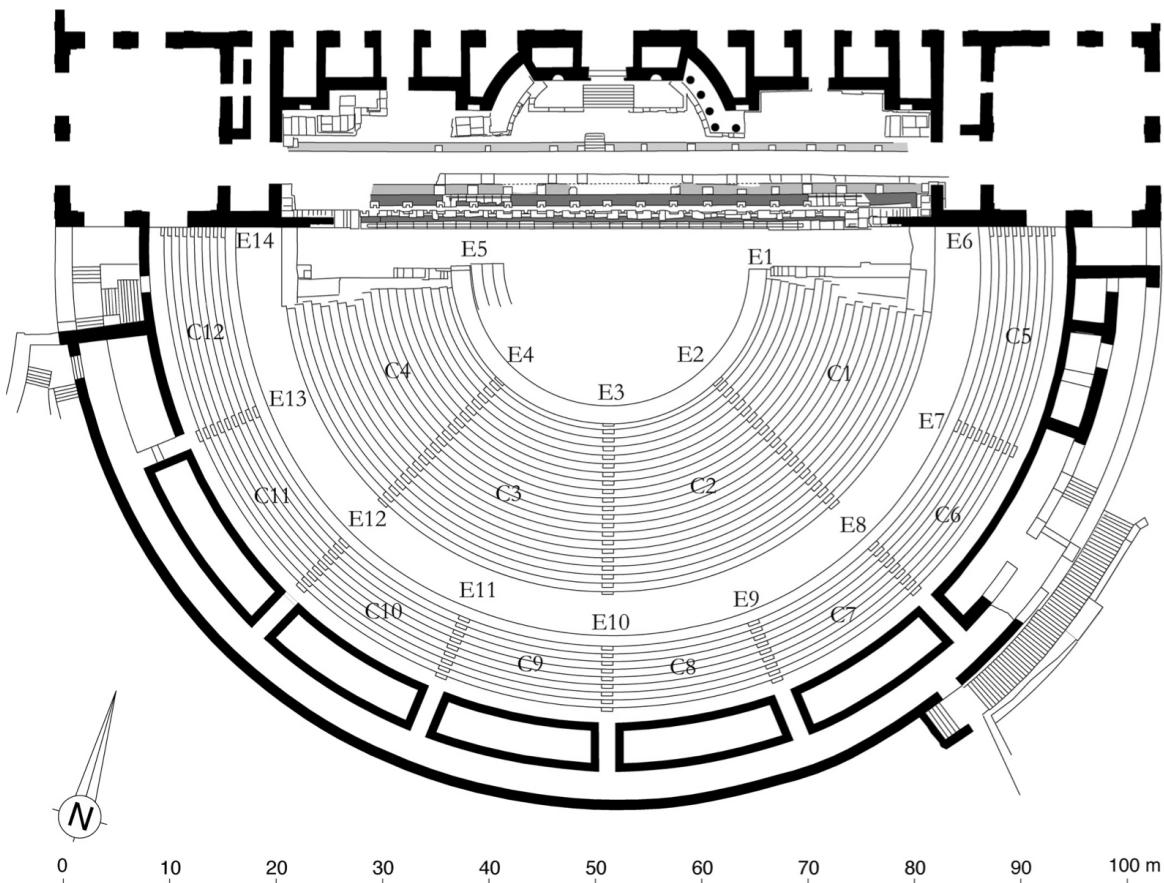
Plan du théâtre au niveau du second ambulacre [BADIE et collab., 2013a, Pl. XVIII]
